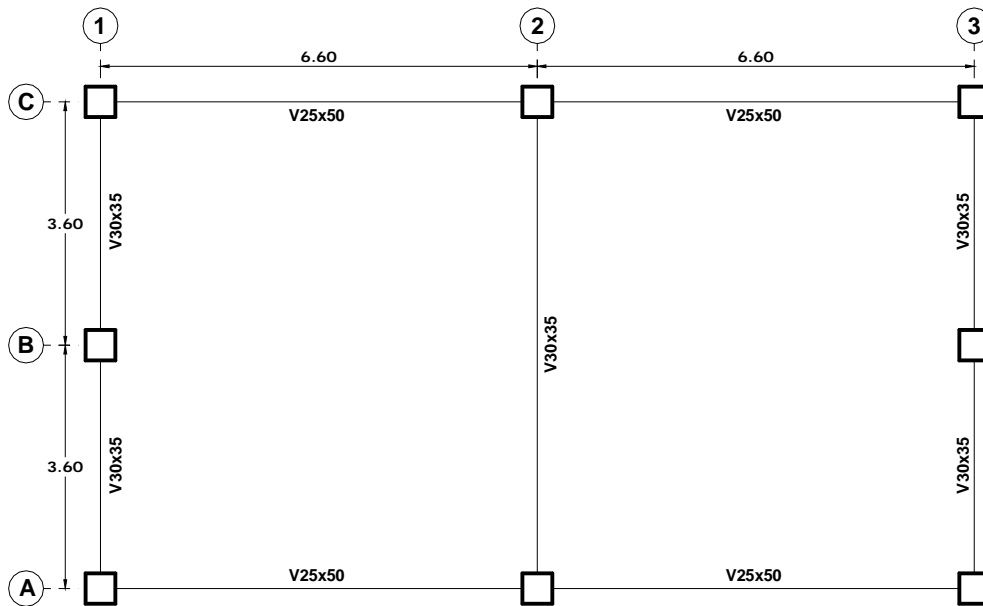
Planta del edificio prototipo para la bajada de cargas
